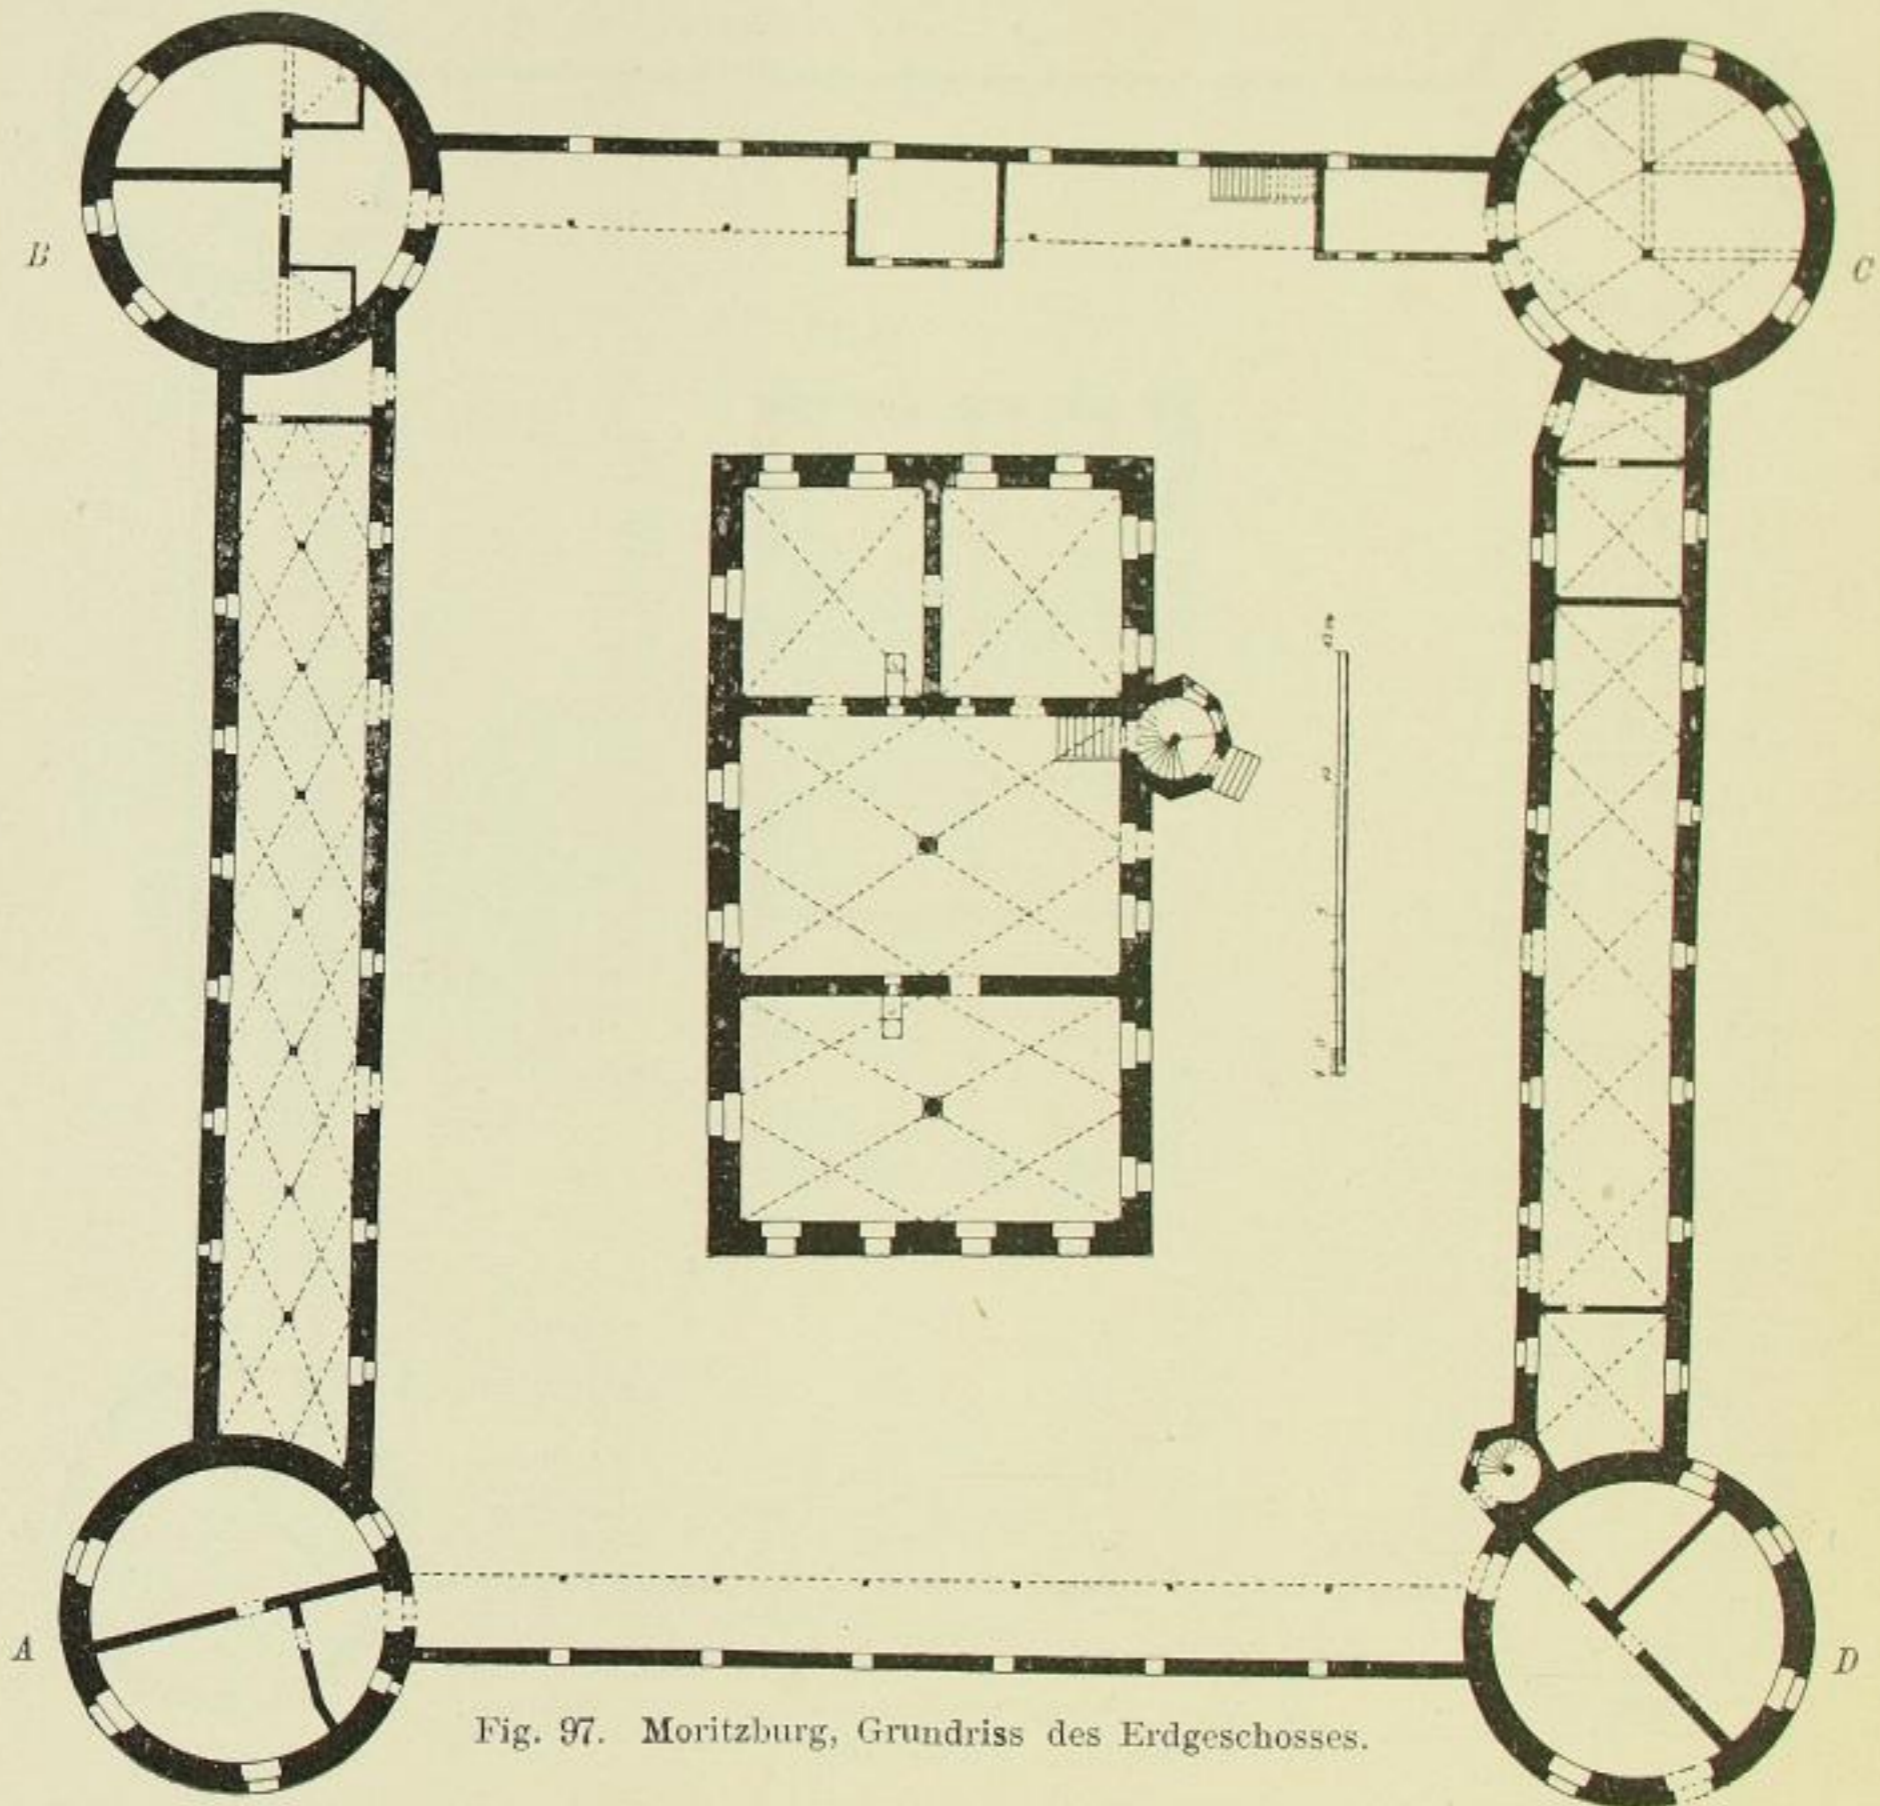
Moritzburg, Grundriss des Erdgeschosses.
